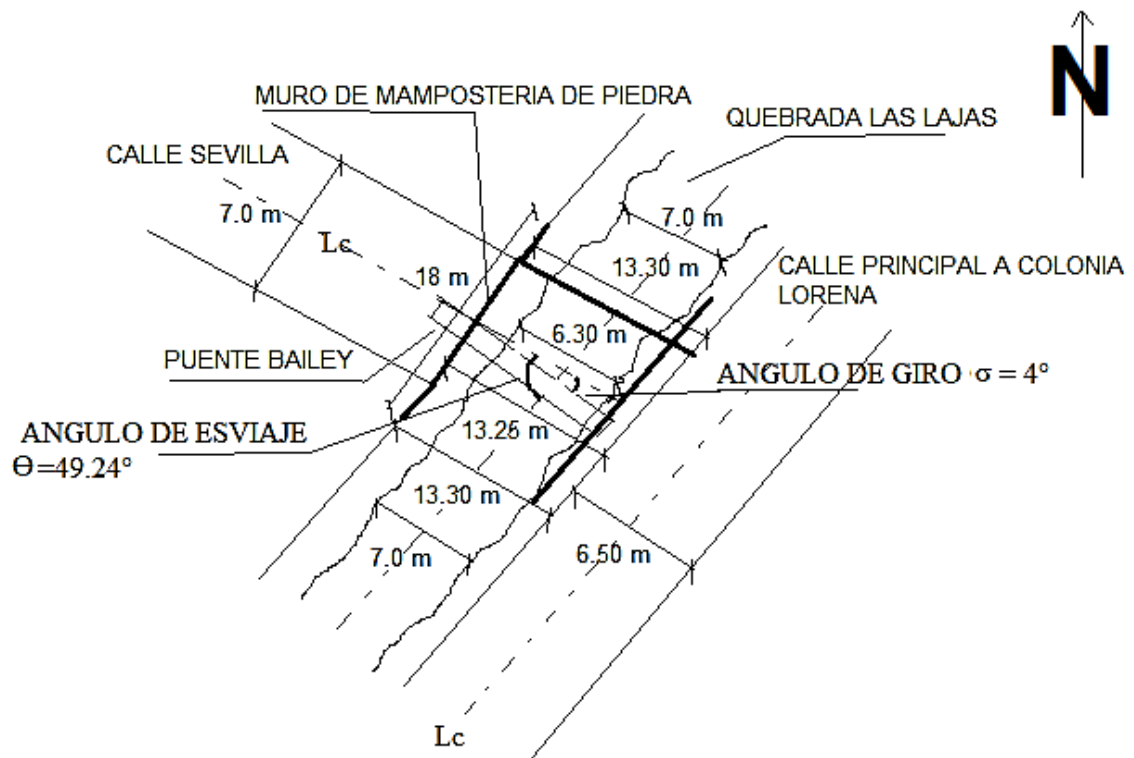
3 Ubicación de detalles en el emplazamiento, sin escala.
